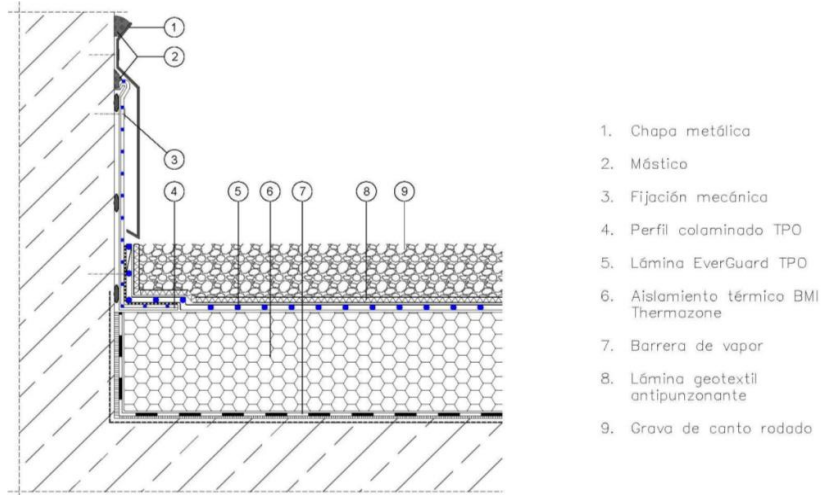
Remate peto perimetral con perfil colaminado.
